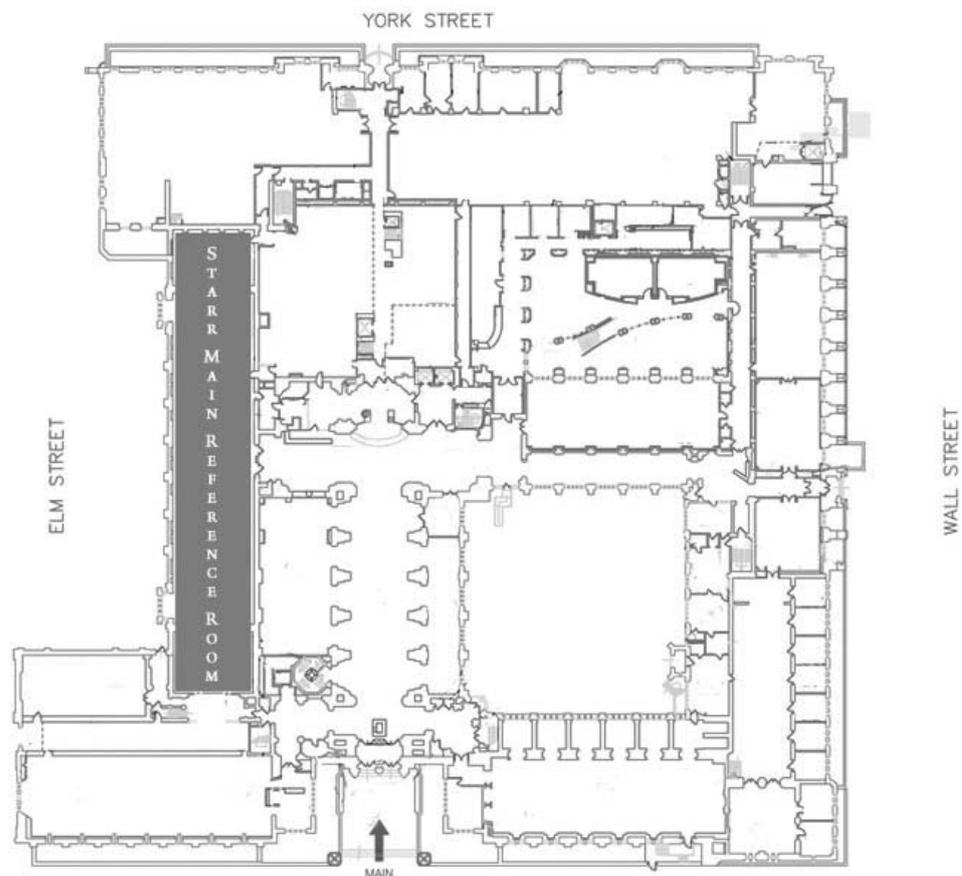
39: Sterling Memorial Library, Grundriss
